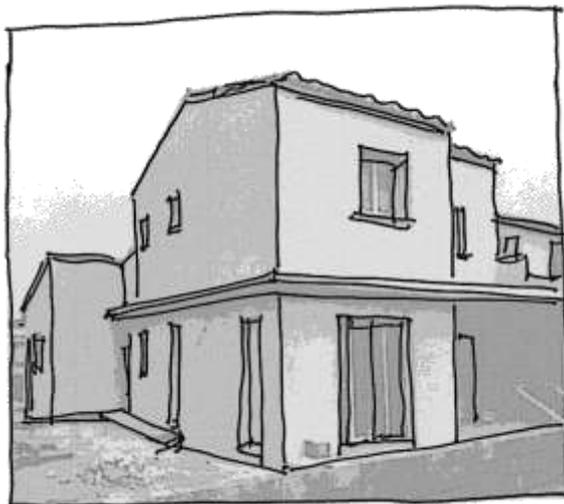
Fachada. Fuente: Álvarez, M.A. (2018, p.302)
